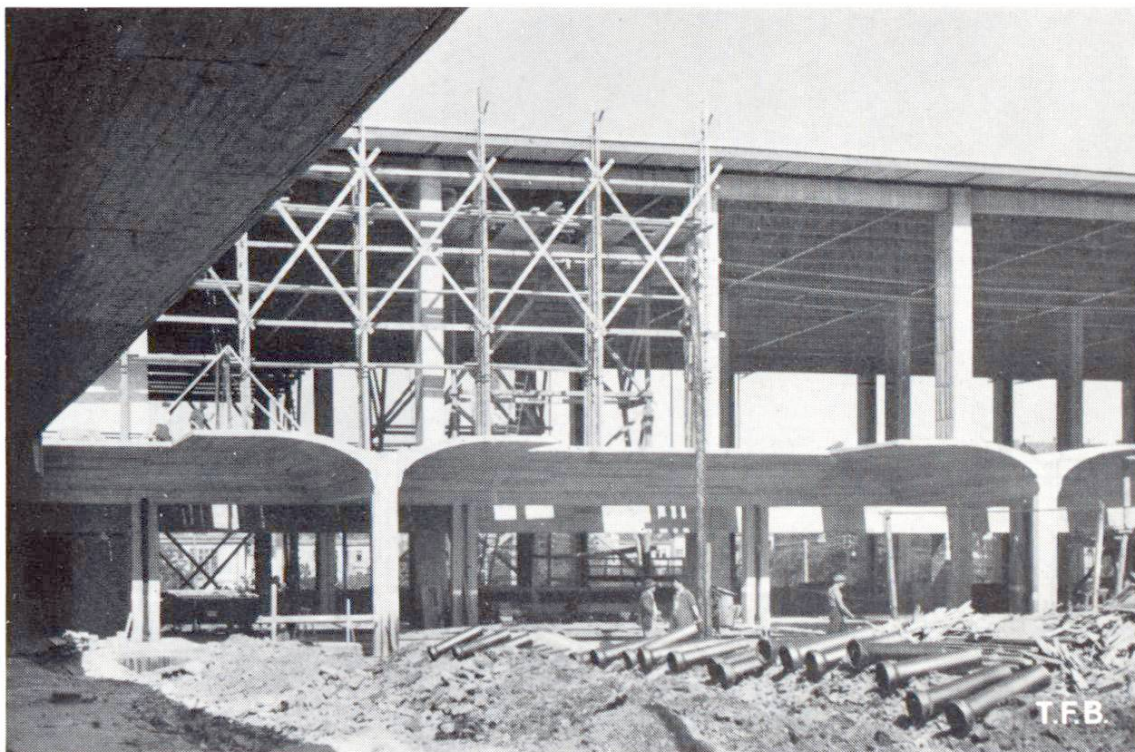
Haupthalle auf Betonstützen. Links Gerüst zum Einbau der Verglasung. Vordächer und Überdachung der Bahnsteige (im Profil sichtbar) in dünnen Eisenbetonflächen
